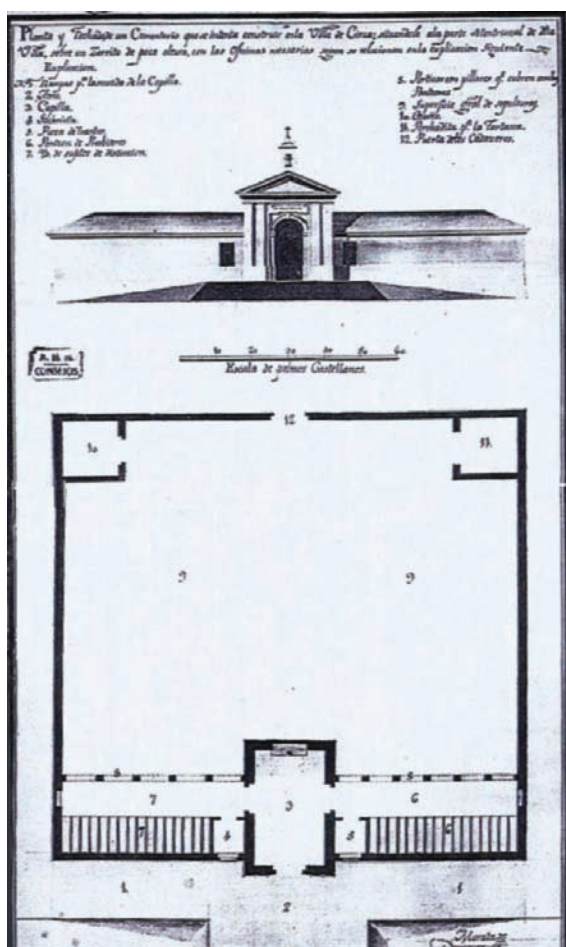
AHN. Sección Consejos, Leg.11877. Planta y fachada de un cementerio que se intenta construir en la villa de Cieza.
